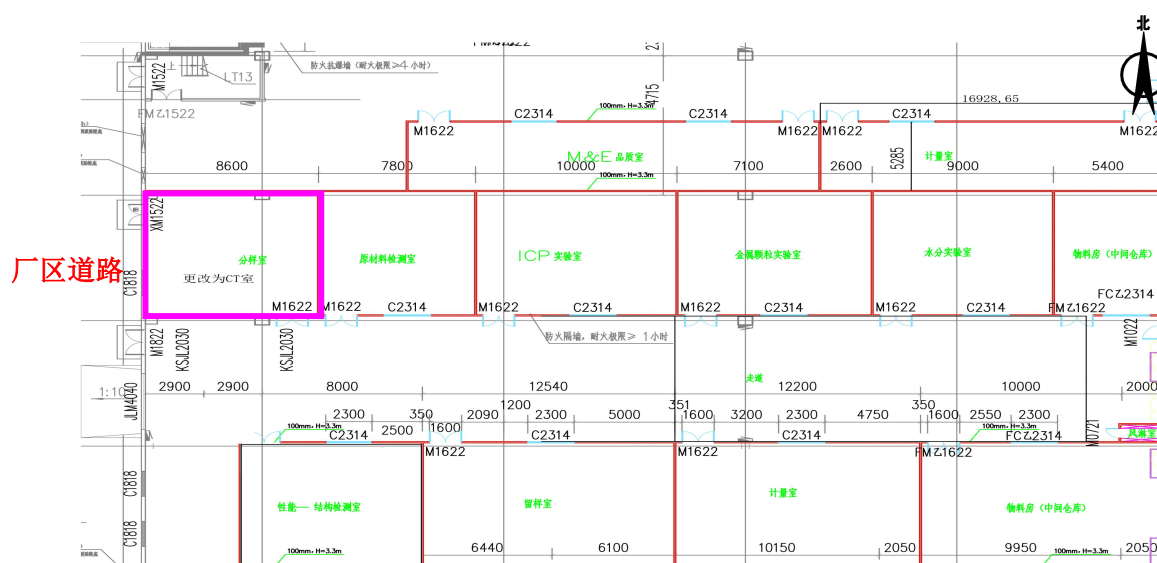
6-2#厂房平面布置图（局部实验测试区）
